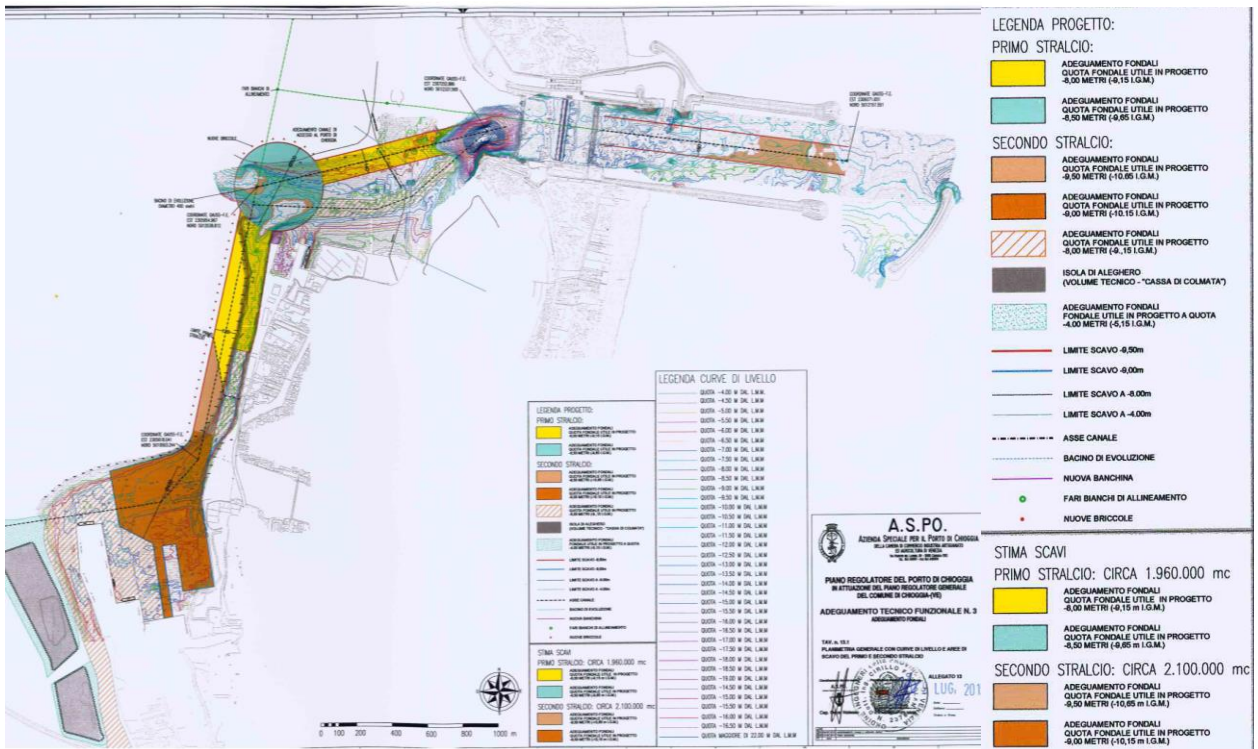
Planimetria degli escavi previsti dall'ATF 3
